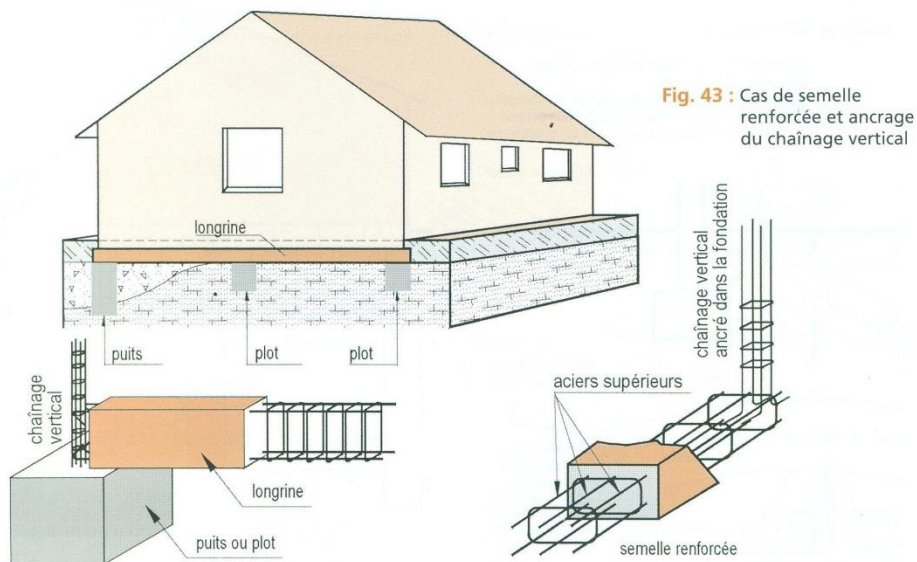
Fondation sur puits ou plot, longrine et chaînage vertical
